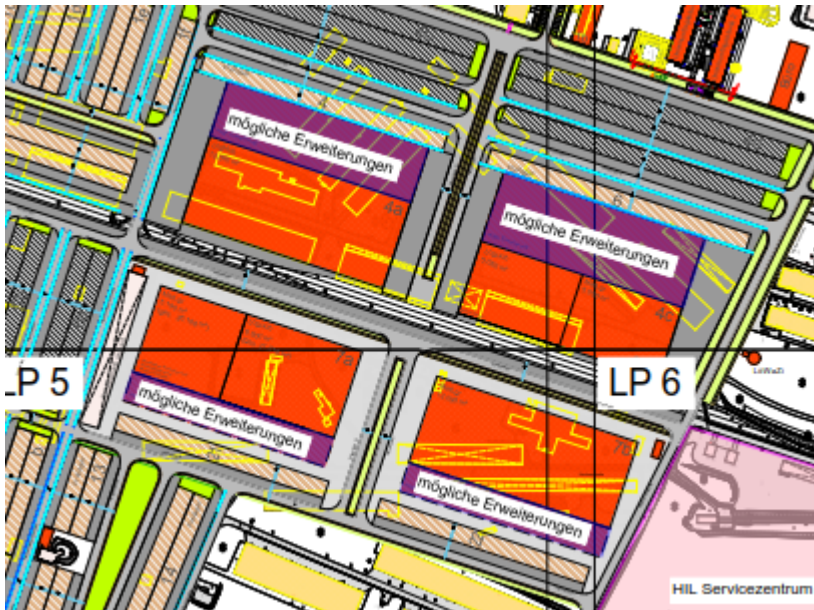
angepasster Lageplan des LbAK (Quelle: Entwurfsplanung Verkehrsanlagen)
